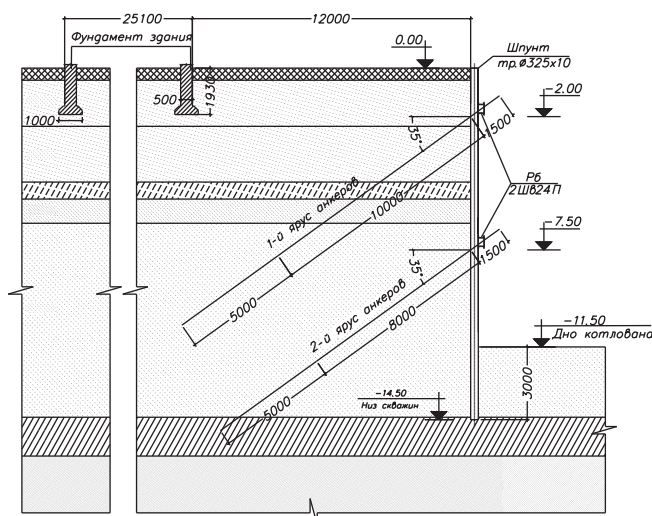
Разрез крепления шпунтовой стенки анкерами
